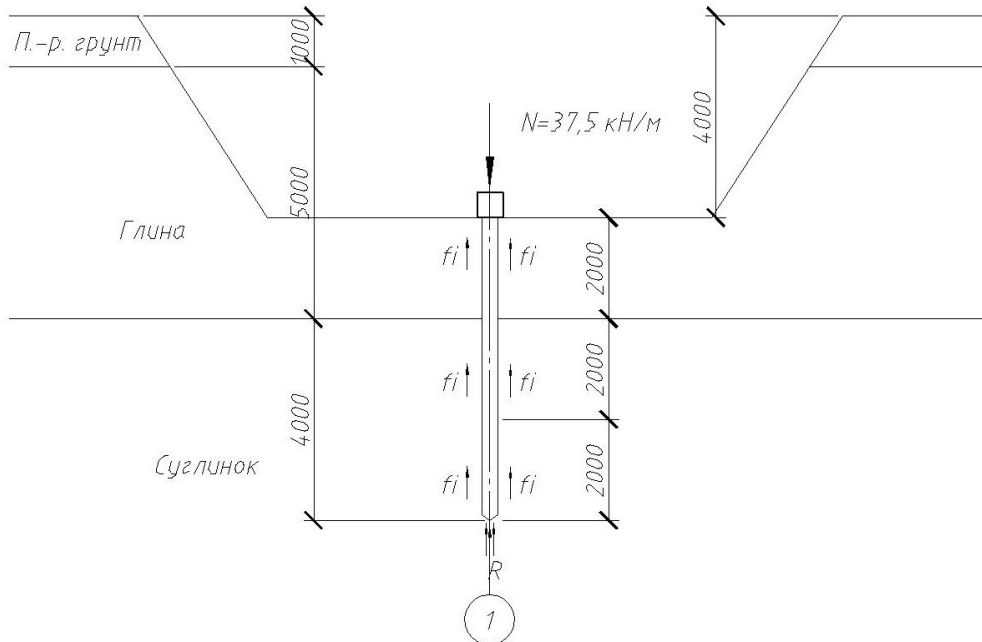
Расчетная схема свайного фундамента под стену цокольного этажа
